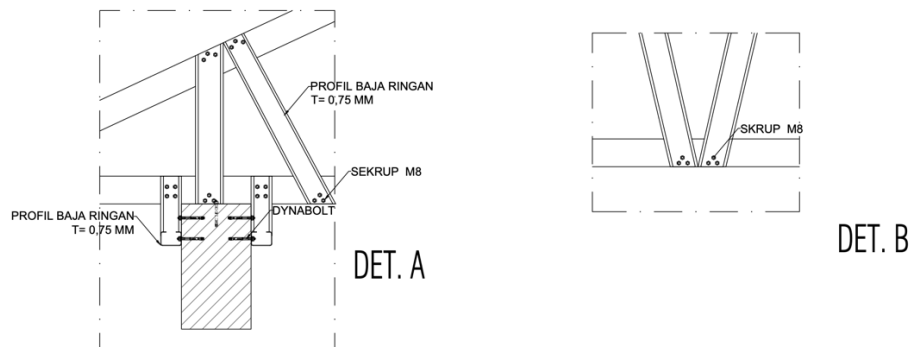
107 Contoh Detail Atap Baja Ringan (1)
